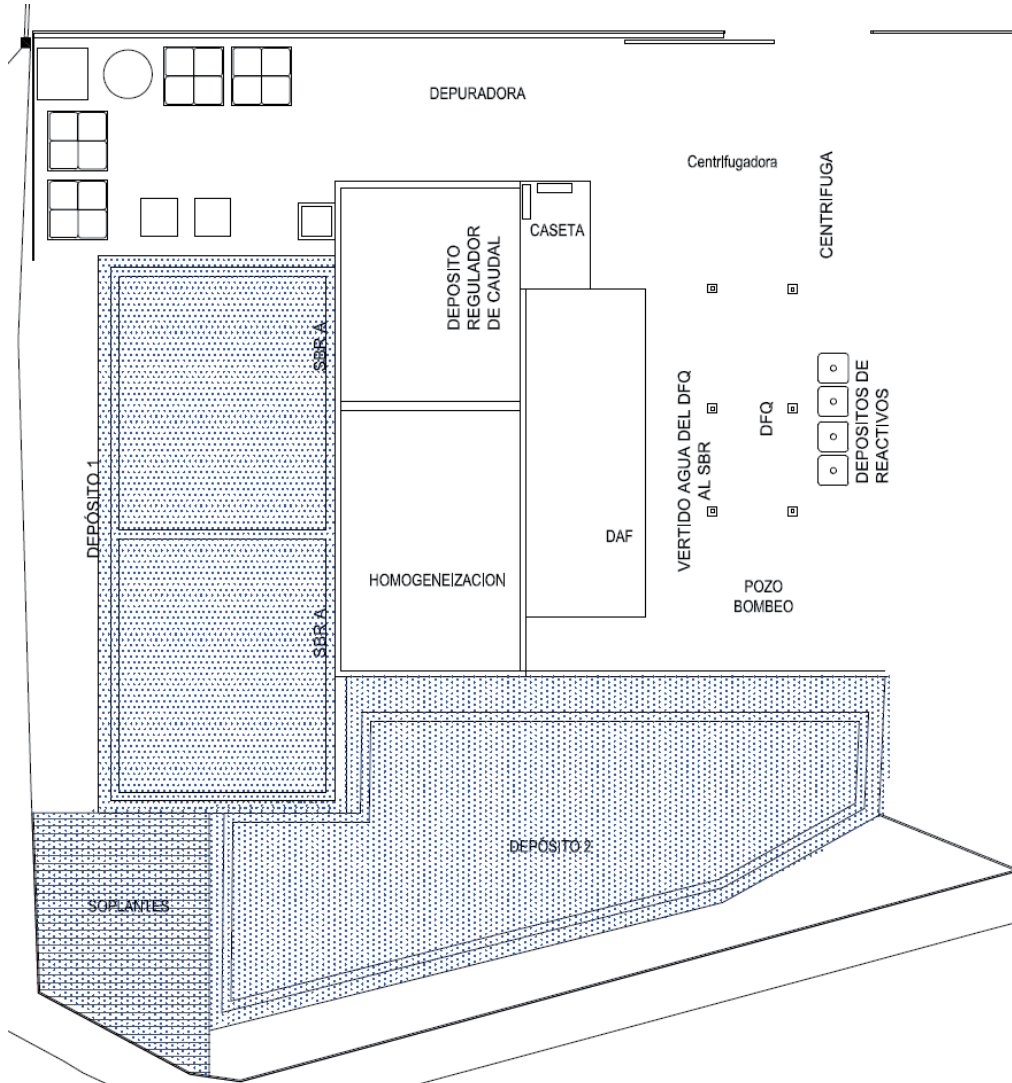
Detalle del plano en planta de la instalación con la zona de la EDARI, en el que se resaltan las modificaciones
